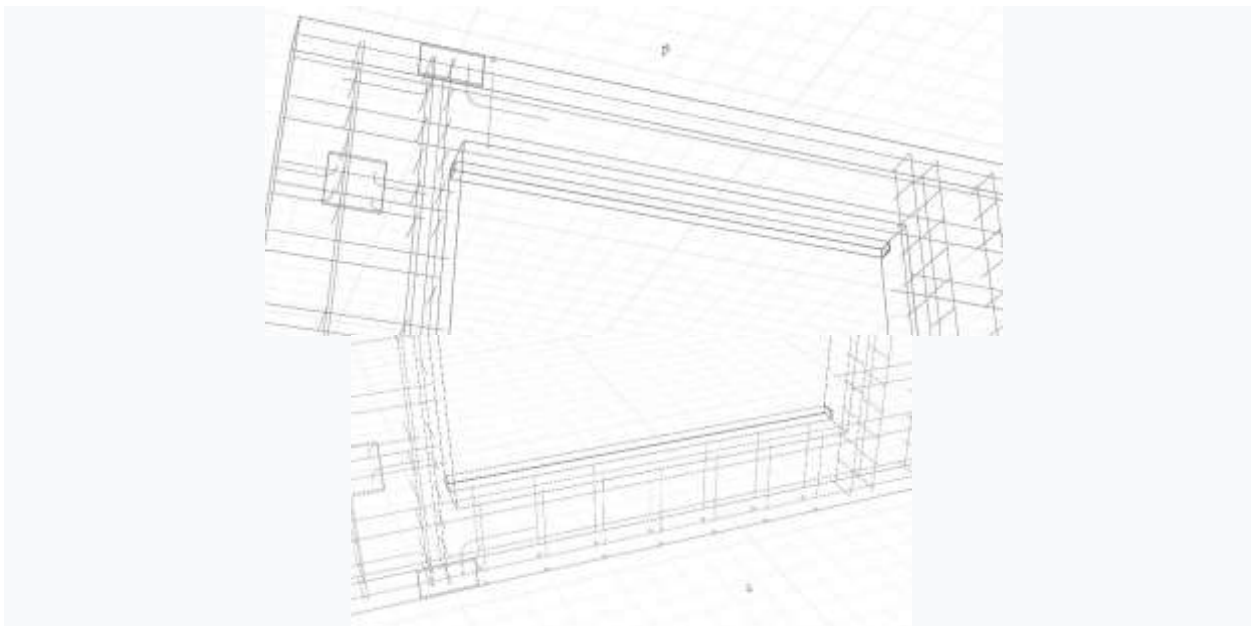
Ручное армирование зоны под проемом. Копирование стержней
